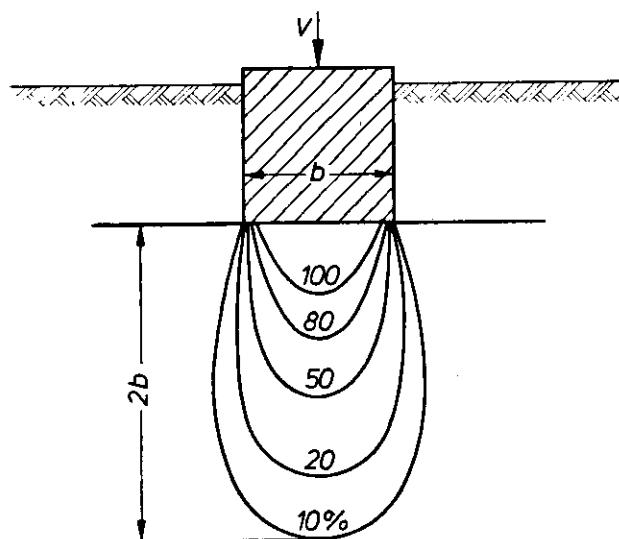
Abbau der Bodenpressung unter einem Einzelfundament
